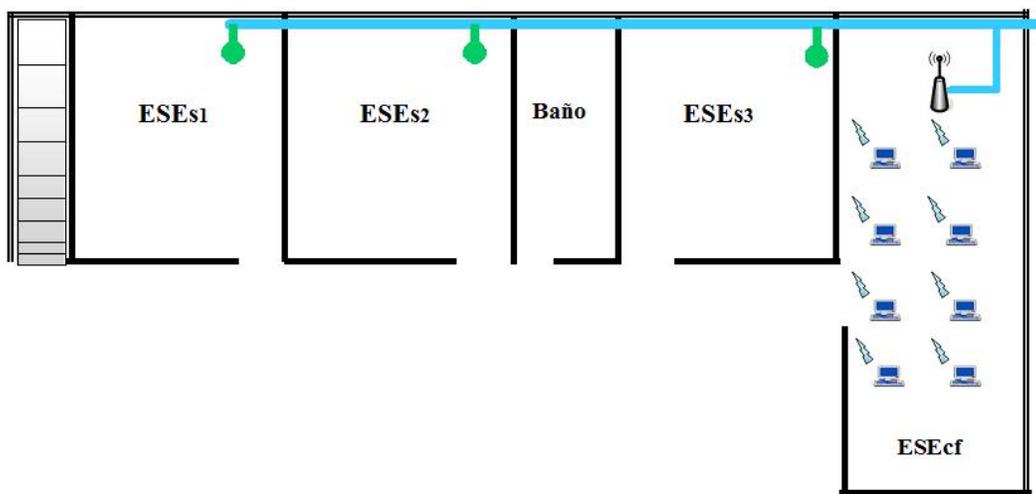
Esquema del Edificio de Secundaria. Nivel 1 ó Planta Baja.
